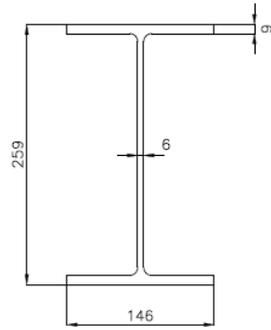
Perfil del acero estructural para soporte de pozos de acceso.
